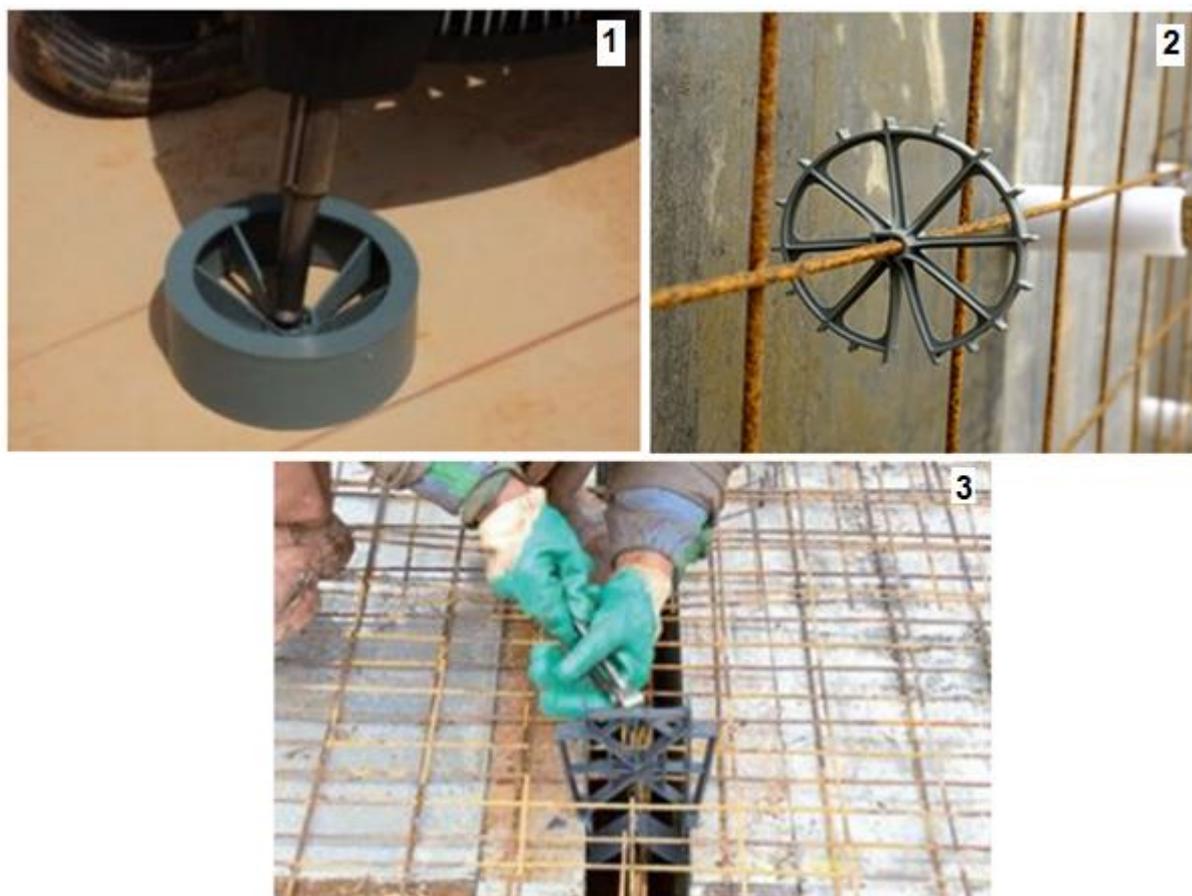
1 Espaçador para base da parede, 2 Espaçador de parede e 3 Espaçador de placas para laje (Fonte do autor)
